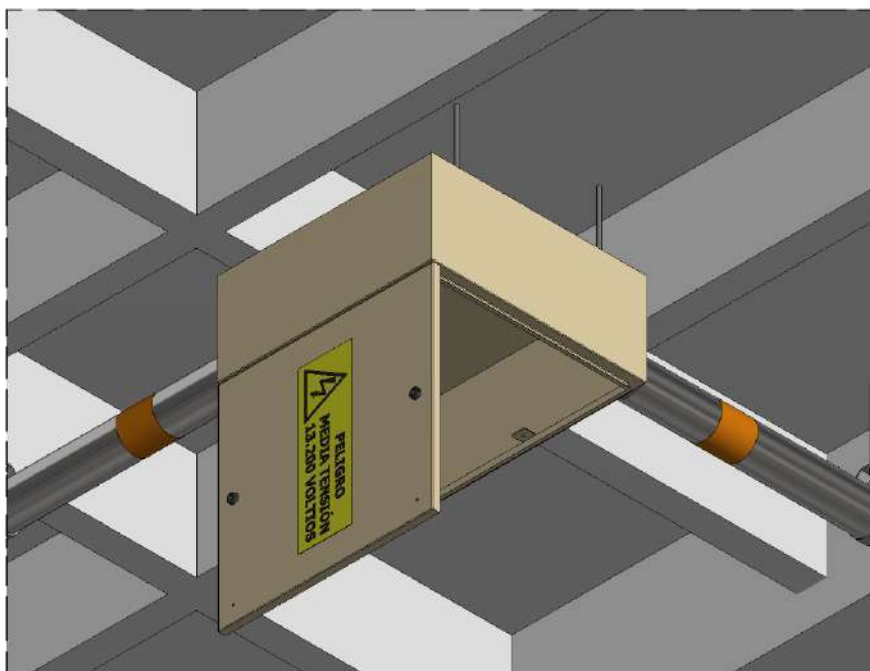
Detalle instalación de cajas metálicas sobre los nervios de la losa – Sujeción de la caja con chazo expansivo
